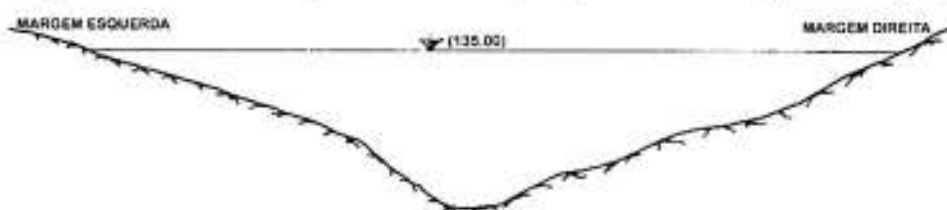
Alçado da barragem do Santa Clara (Fonte: portal INAG – Barragens de Portugal)
